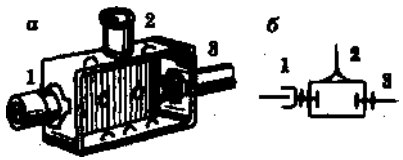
Ответвительная труба к корпусу: а — внешний вид; б — условное обозначение; 1 — патрубок с аааемляю^деми цапааующими гайками; 2 — муфта, приваренная к коробке; 3 — ввод трубы с полусгоном
